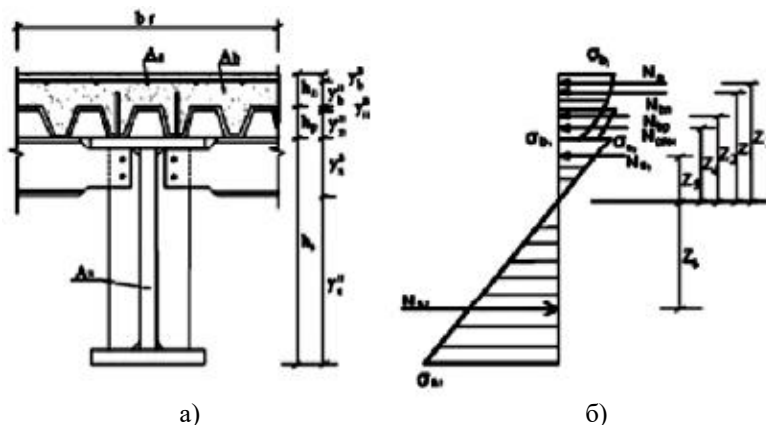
Расчетная схема бетонного сечения с профнастилом и стальной балкой: а) сечение главной балки с сопряженной балкой настила; б) эпюра напряжений и внутренние усилия (иллюстрация автора)
